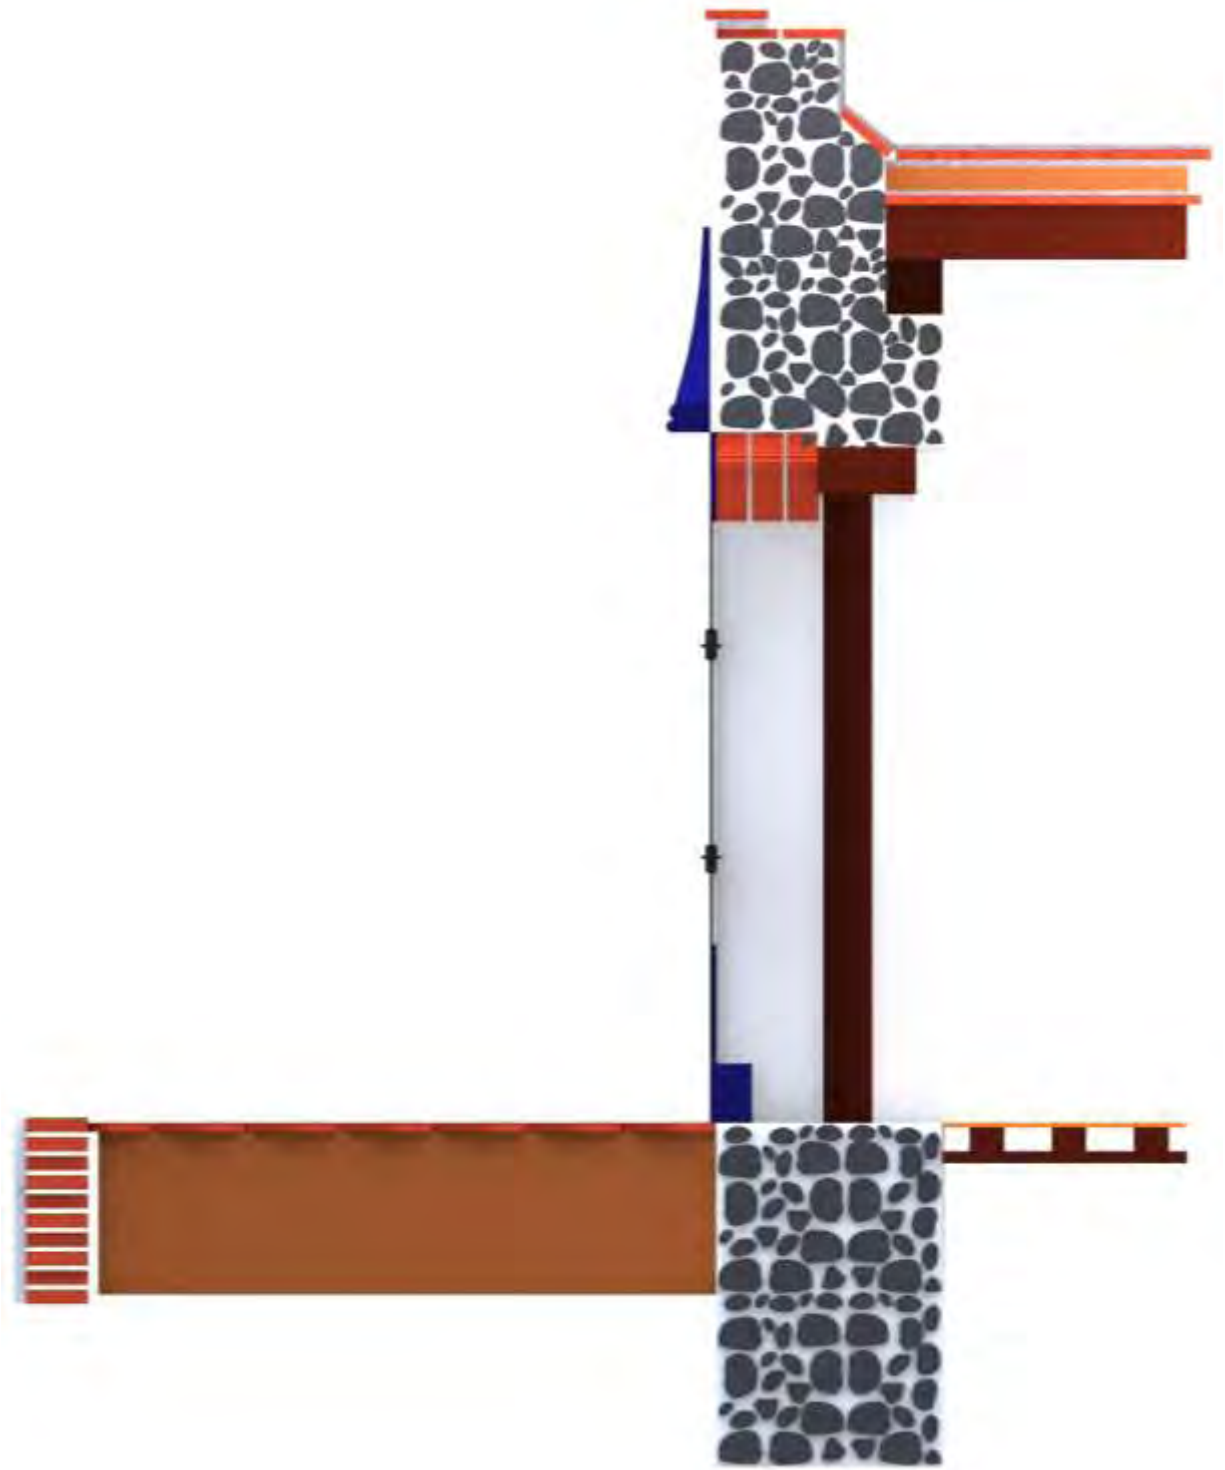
Corte de la fachada principal de la Casa del Hacendado.
